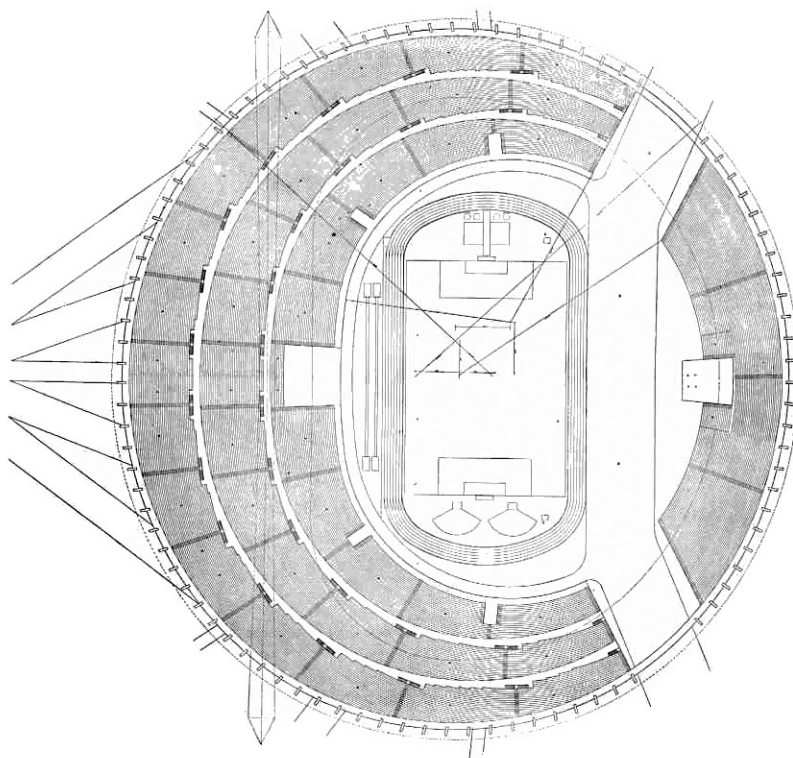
Planta-baixa do Estádio Nacional. Fonte: PAPADAKI, 1950.
